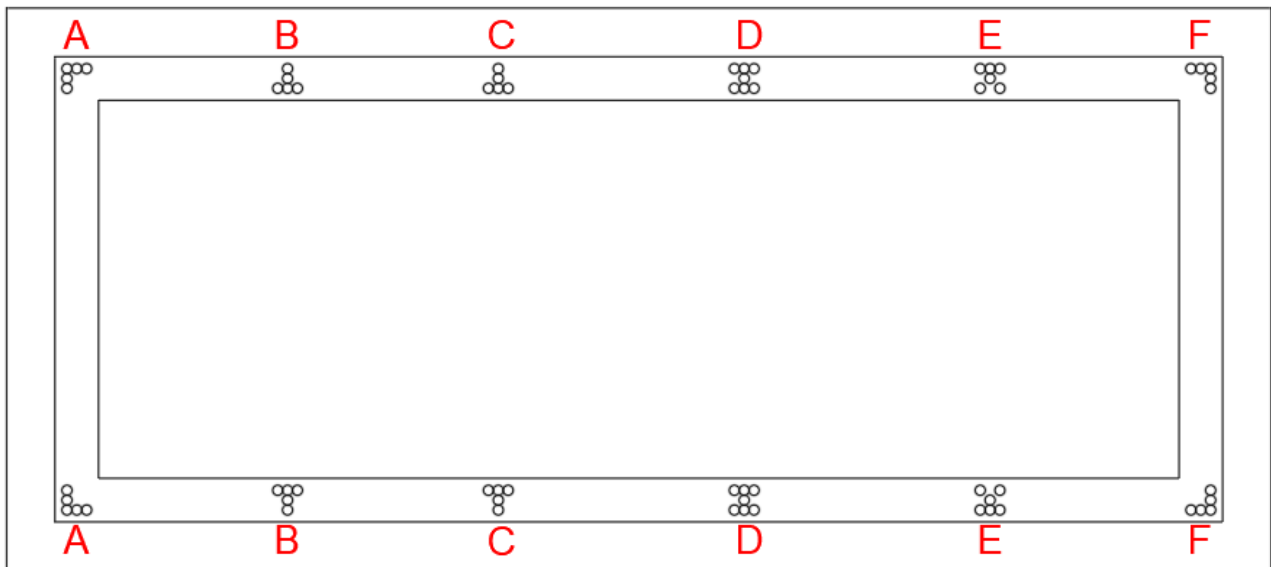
Prospetto Frontale e Prospetto Sud dell'edificio con la disposizione dei culmi.
